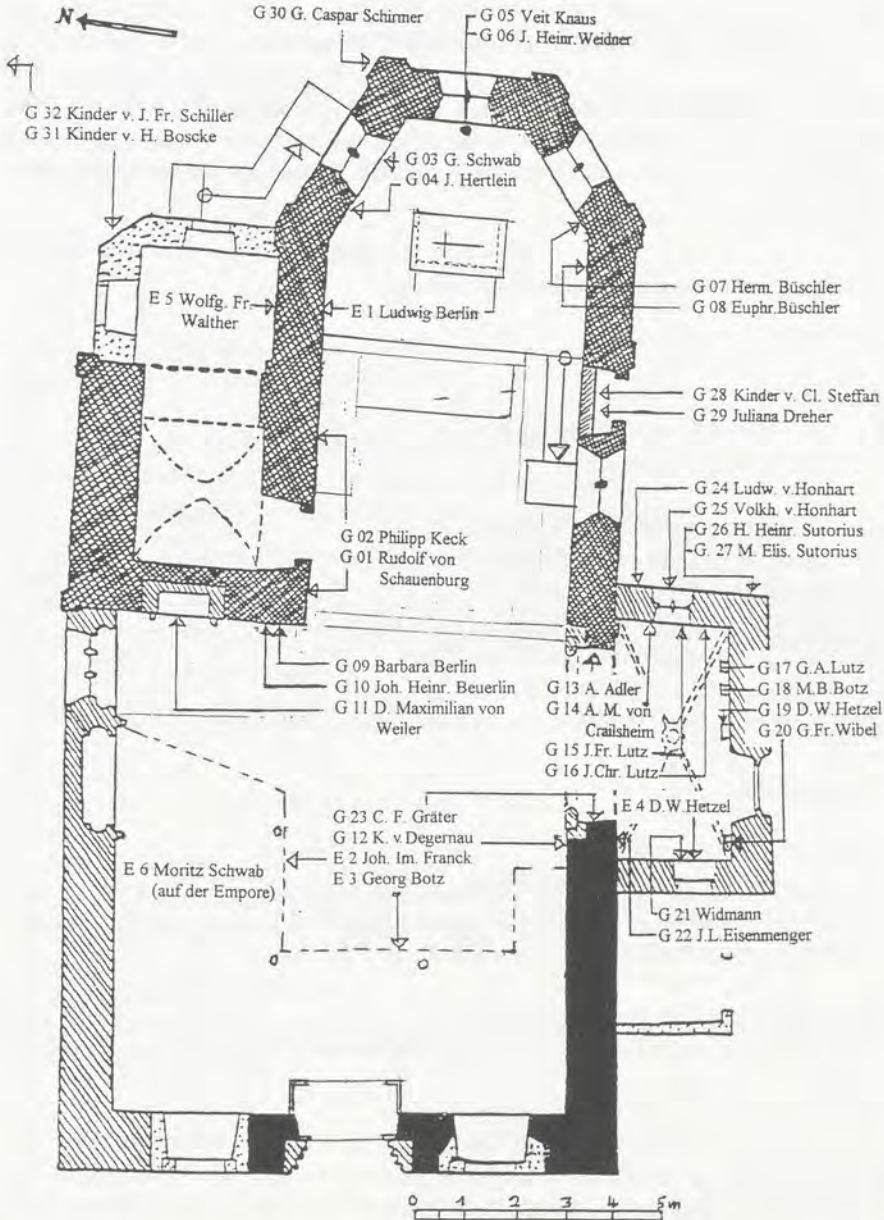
Grundriss der Urbanskirche 1:100 mit Bezeichnung der Personendenkmale (Mauerwerk schwarz: um 1230, dunkel schraffiert: um 1250; hell schraffiert: um 1450, punktiert: 18. Jahrhundert)
